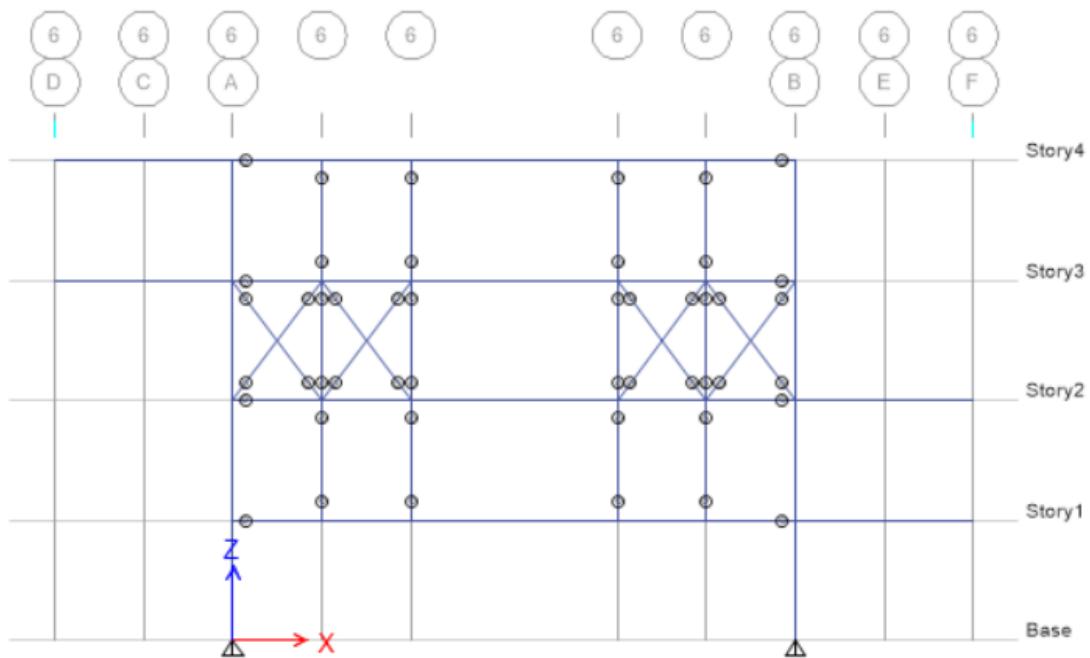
10 Potongan 2-2, 4-4, dan 6-6 Konfigurasi Pratt Truss
